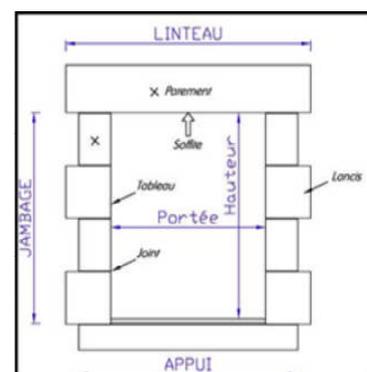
Chambranle en pierre de taille : encadrement ornemental et renforcement structurel. (Source : www.wilkepedia.com)
